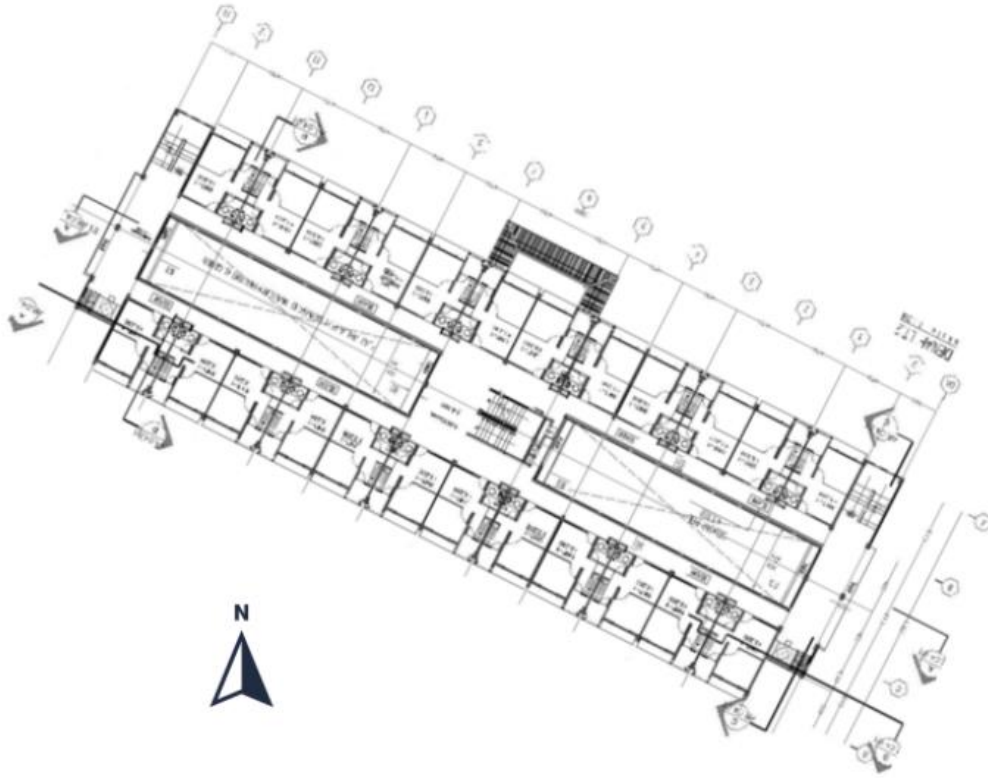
Denah Lantai Dasar Rusunawa Type 24
